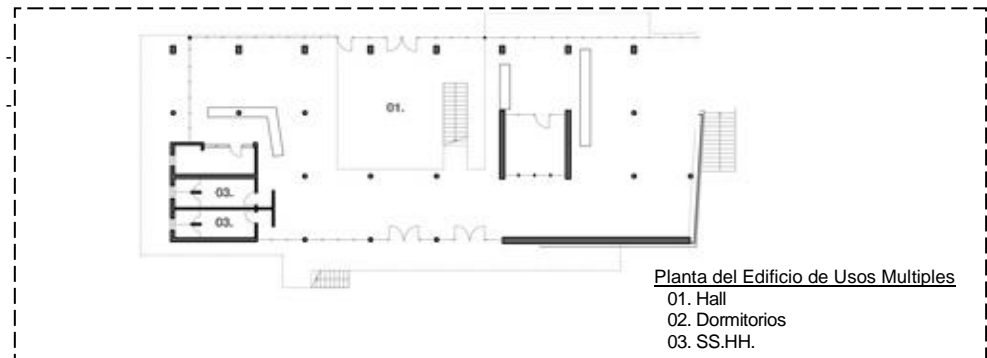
Planos de Plantas del Edificio de Alojamiento – Tipo 2
